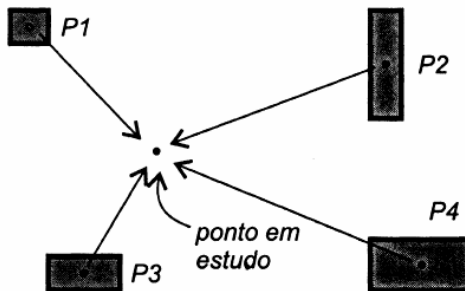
Contribuições de cada pilar para o ponto em estudo.
